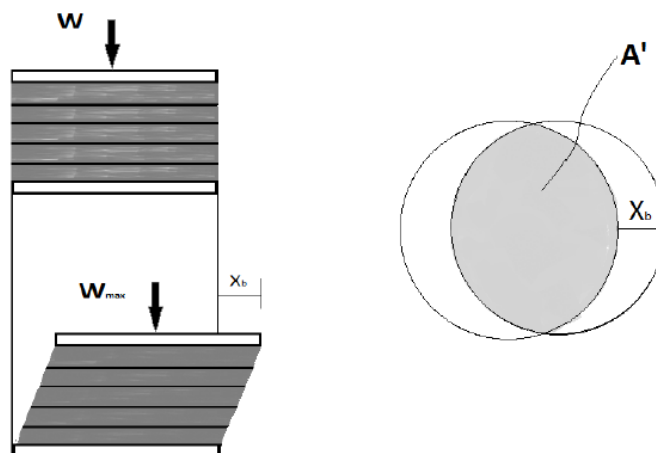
Zona de superación entre la zona fija y la zona desplazada una distancia X_b del aislador.
